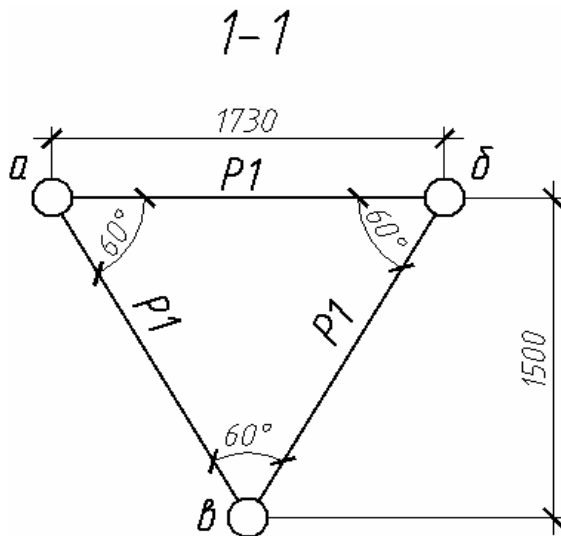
Вид поперечного сечения трубобетонной сквозной арки.
